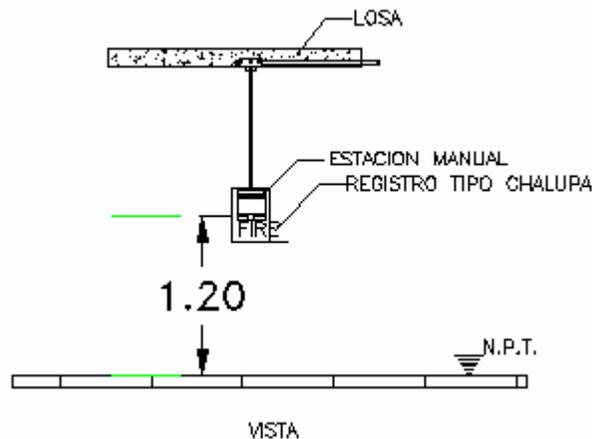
Detalle de soportaría para una instalación eléctrica.
